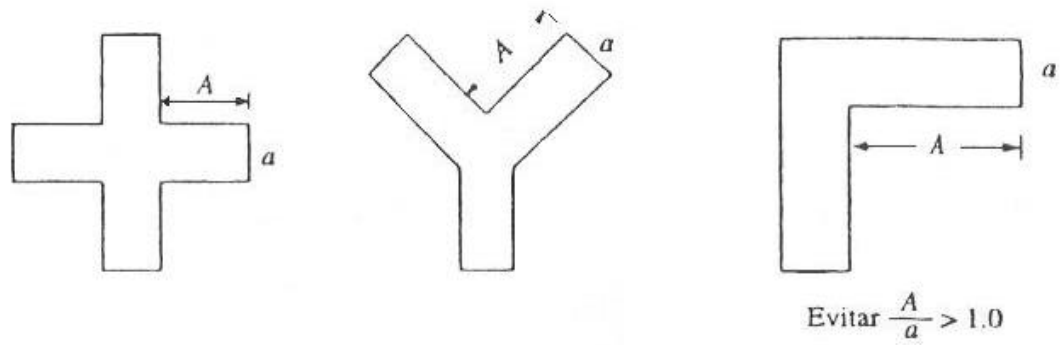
Planta con alas muy largas [Bazán, E., Meli, R. (2002)]
